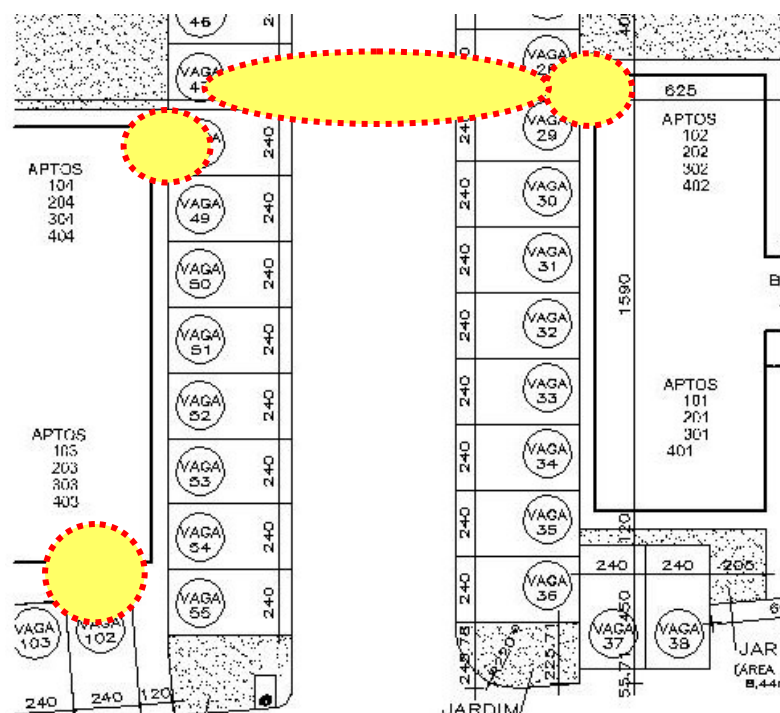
Recorte da implantação do Residencial Tocantins 1. Fonte. Processo SEPLAN nº 4620/2014.
